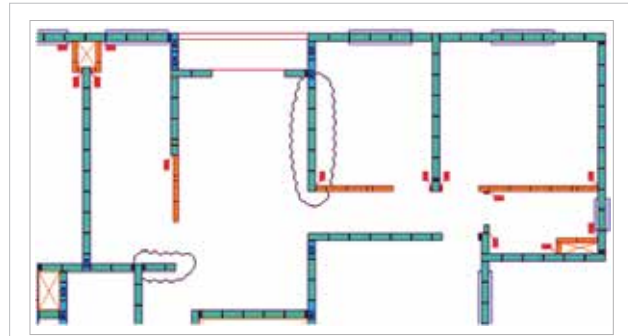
Projeto modificado para permitir o uso de lajes pré-moldadas
